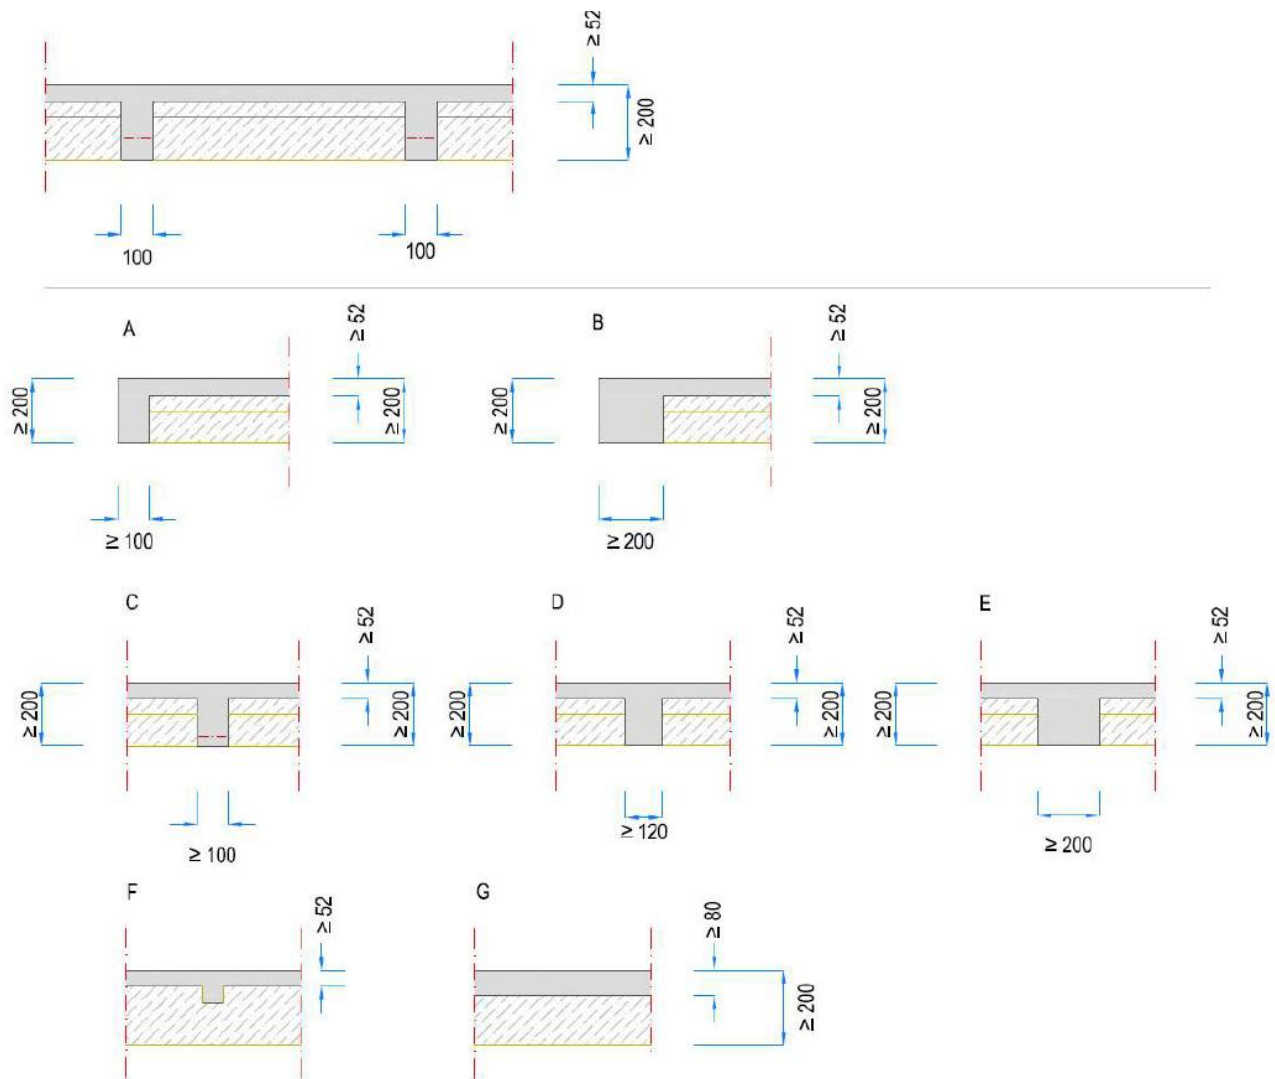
Sección estructural con aislamiento entre nervios rectangulares.
